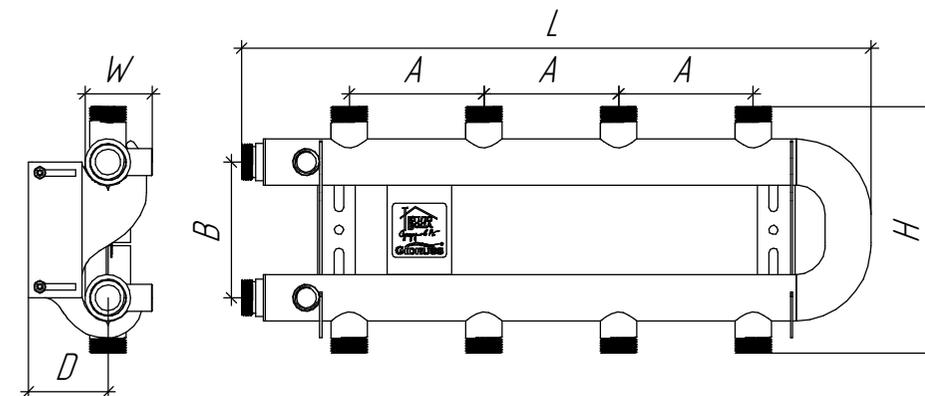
Габаритно-присоединительные размеры кольцевых коллекторов RMSS-60
